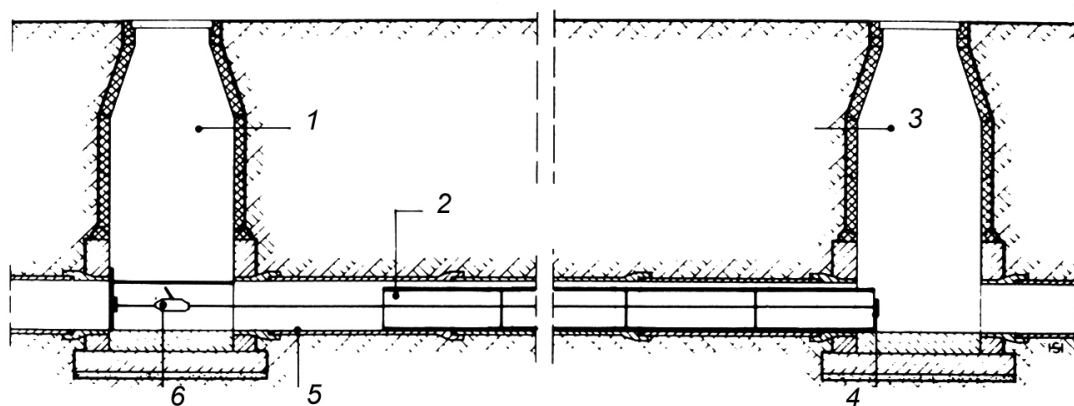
Монтаж нового трубопровода без растягивающих усилий: 1 – целевая шахта; 2 – новые трубы; 3 – стартовая шахта; 4 – опорная траверса; 5 – поврежденный трубопровод; 6 – лебедка.
